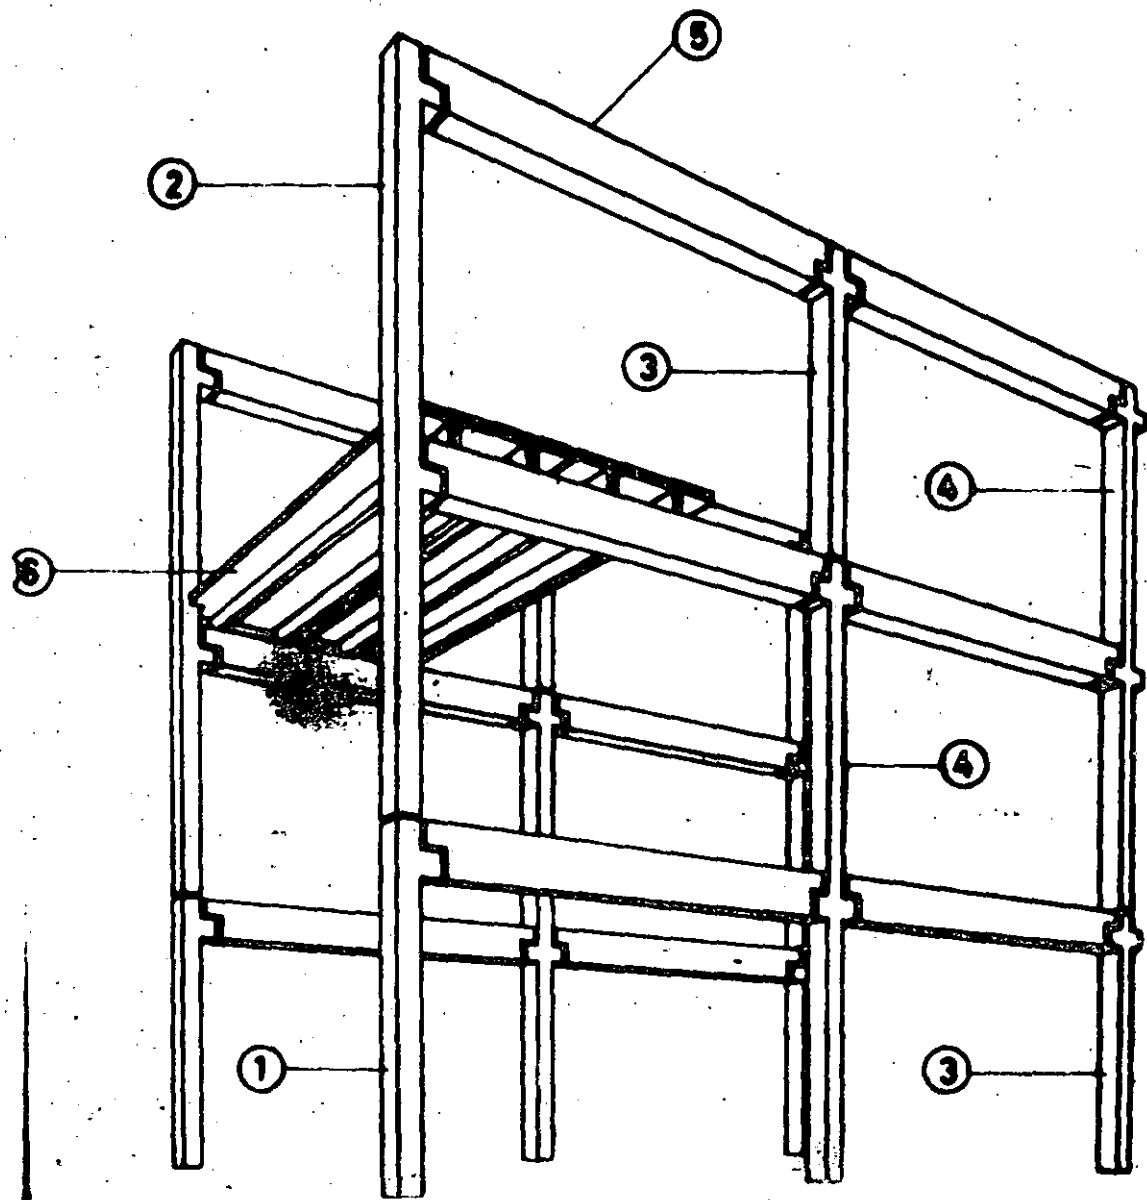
Pilares, 1 y 2, entre de dos plantas de altura, con disposición alternada, 3 ; 4, vigas, 5 y placas de forjado, 6.
